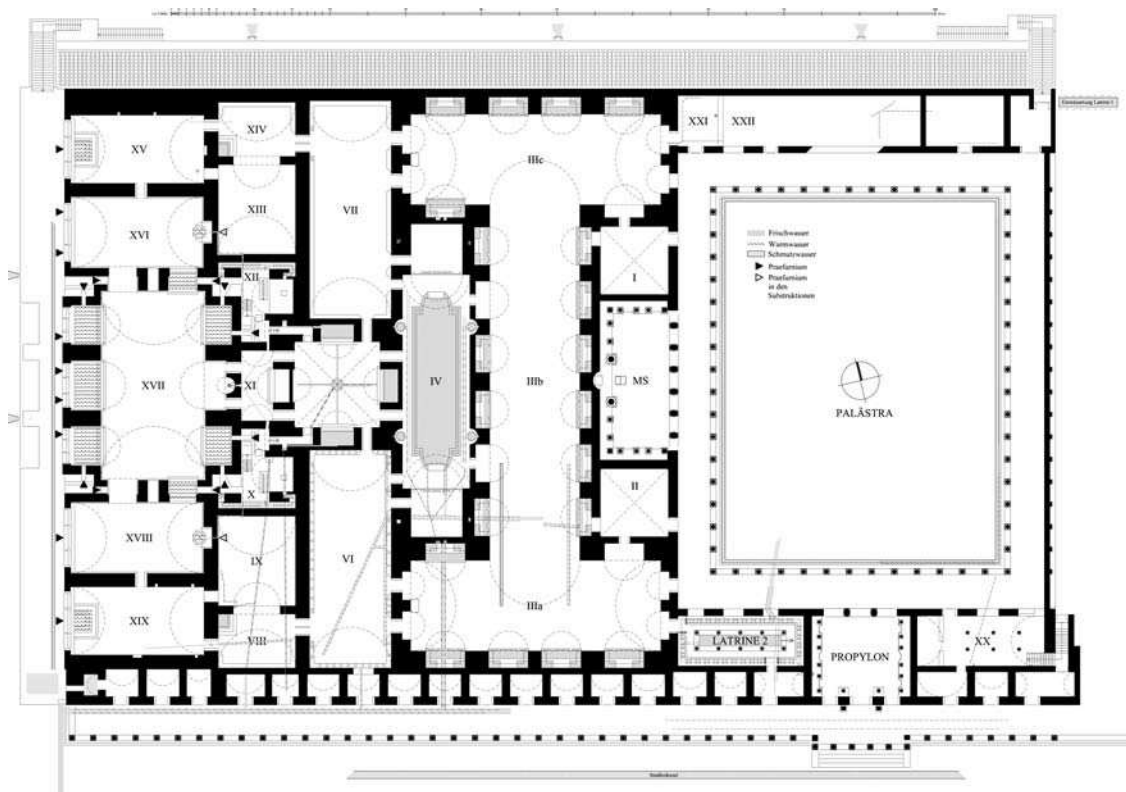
Grundriss mit Eintrag der Wasserinstallationen: Frischwasser, Warmwasser, Schmutzwasser (M. La Torre).
